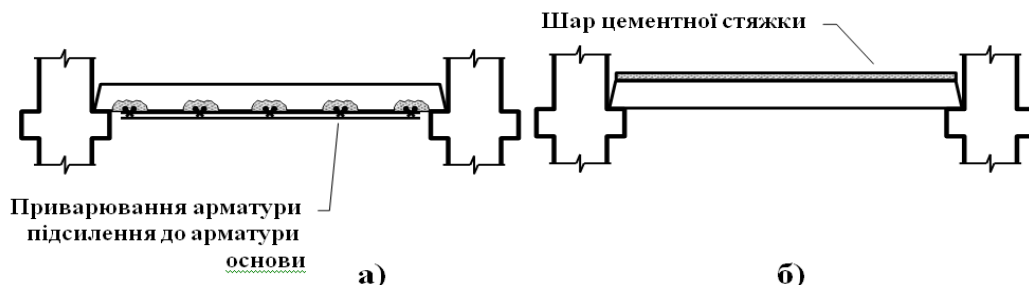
Підсилення залізобетонних плит нарощуванням перетину:
